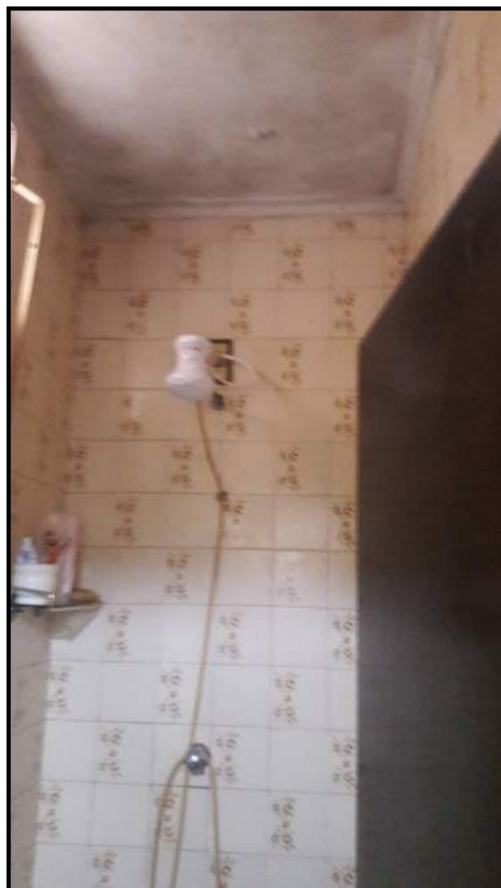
Banheiro térreo frente- piso cerâmico, parede em azulejo.
